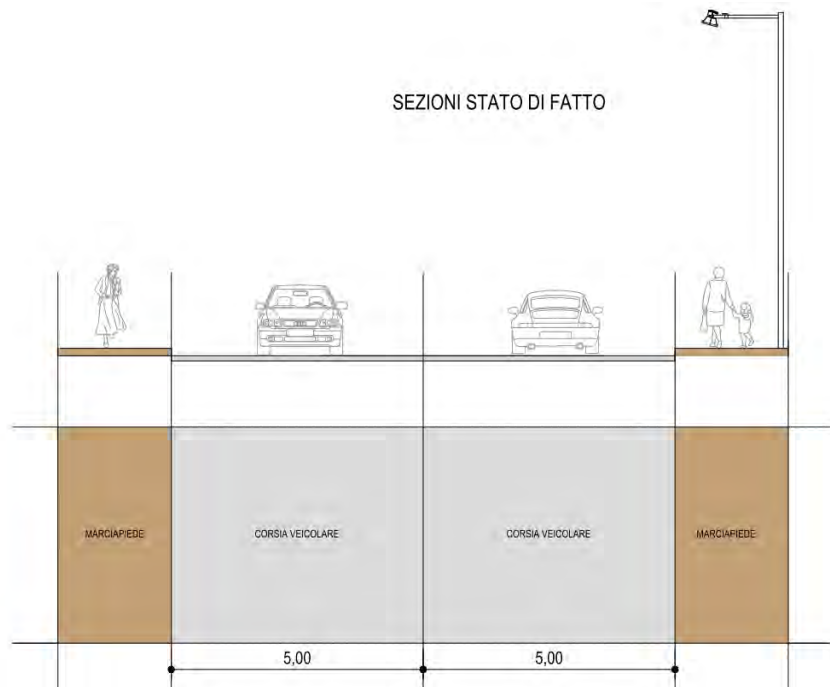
Attuale sezione tipo di via Sanvito Silvestro
